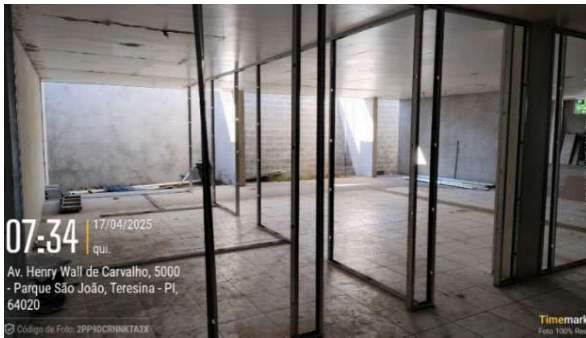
Instalação de paredes de drywall em diversos ambientes na ADM19-ROX .
